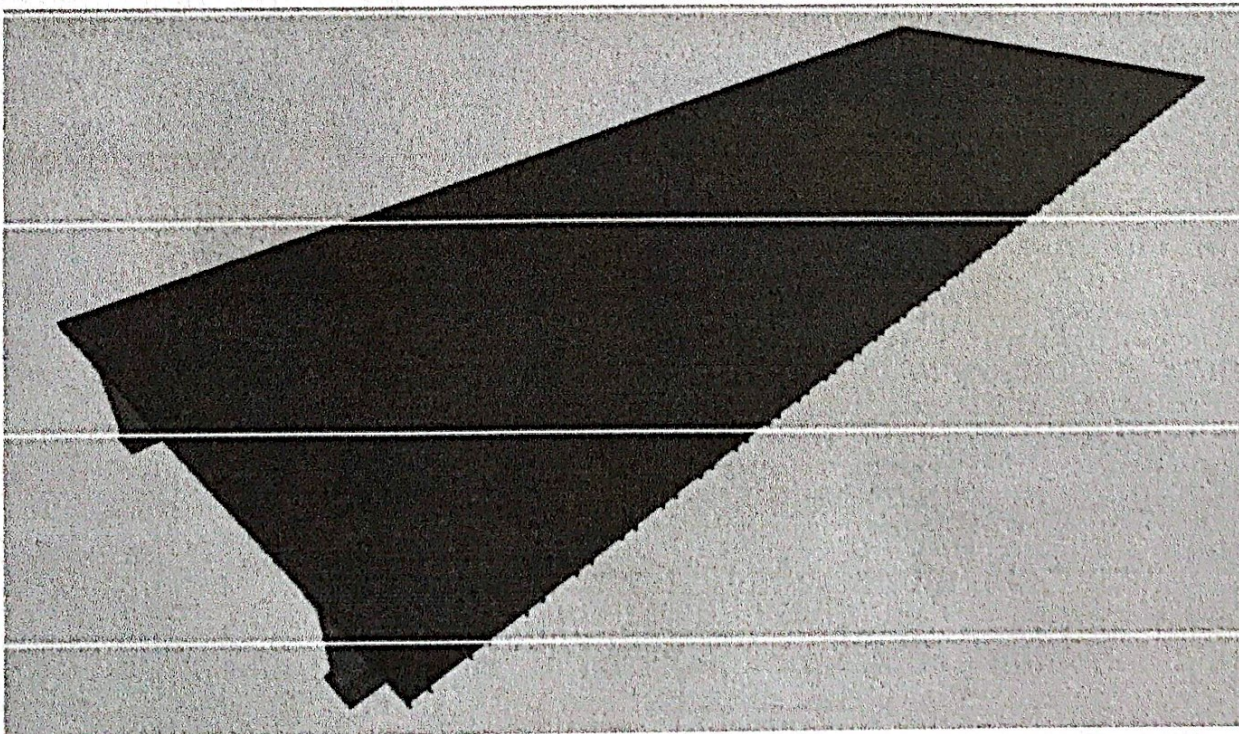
Vista simplificada da estrutura metálica com chapa da pista de rolamento
